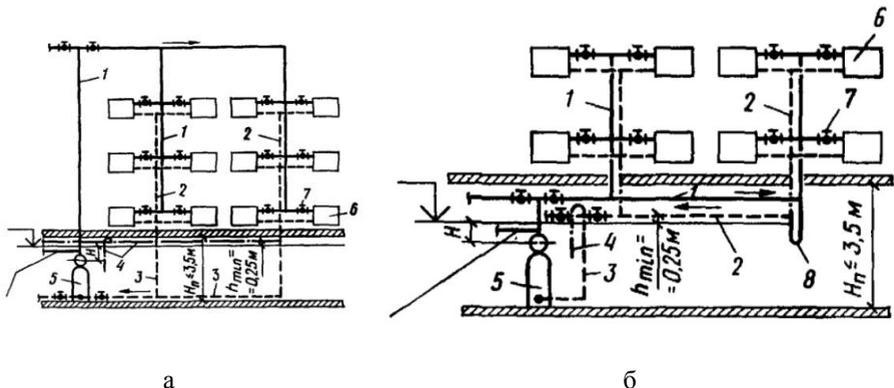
Схеми систем парового опалення низького типу замкнутих відкритих: а – з верхнім розведенням паропроводу; б – з нижнім розведенням паропроводу; 1 – паропровід; 2 і 3 – сухий і мокрий безнапірний конденсатопроводи; 4 – повітряна труба; 5 – котел; 6 – опалювальний прилад; 7 – вентиль; 8 – гідравлічний затвор
